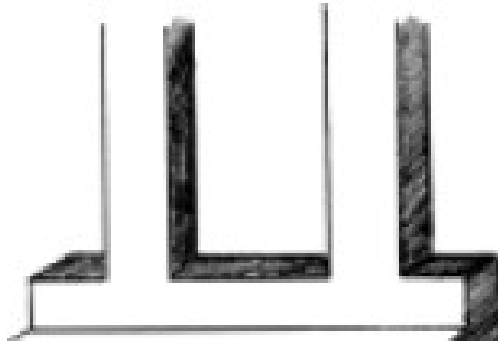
Viga baldrame. Fonte: Modificado de ABCP (2003)
